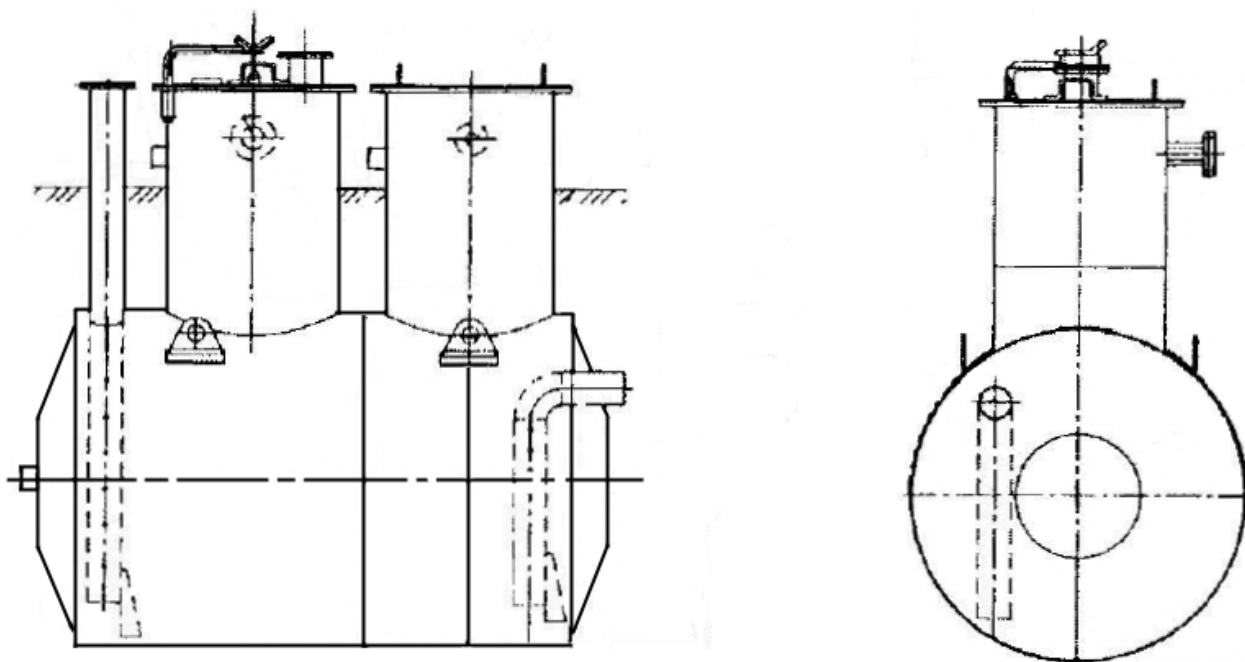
Общий вид резервуара ЕП-5-1600-2-А-СО-У1
